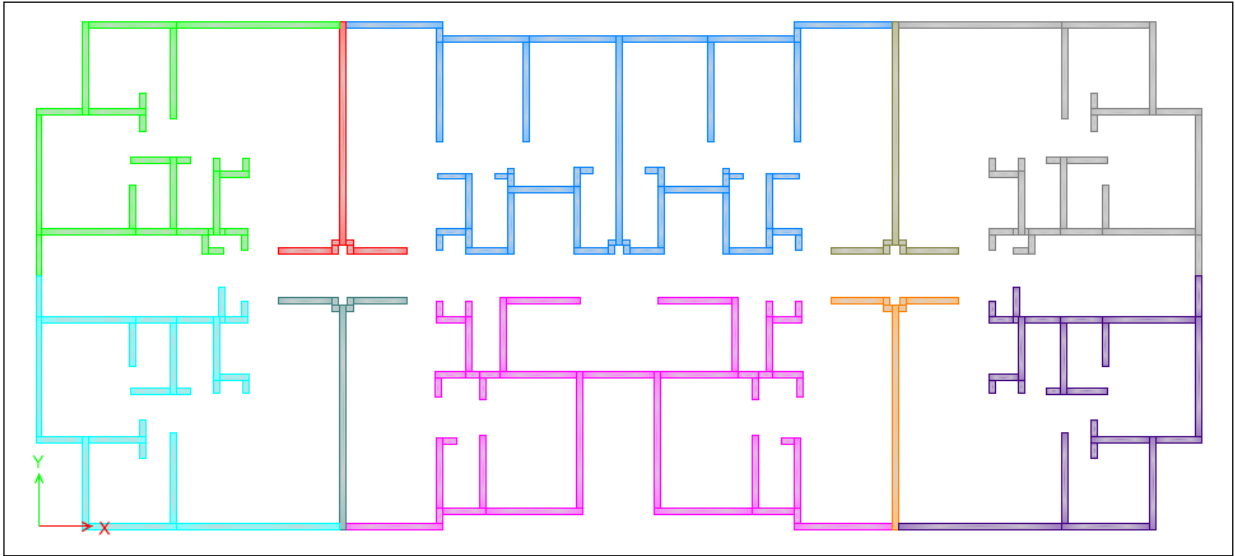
Vista en planta del Edificio I (elementos tipo barra de sección transversal irregular)
